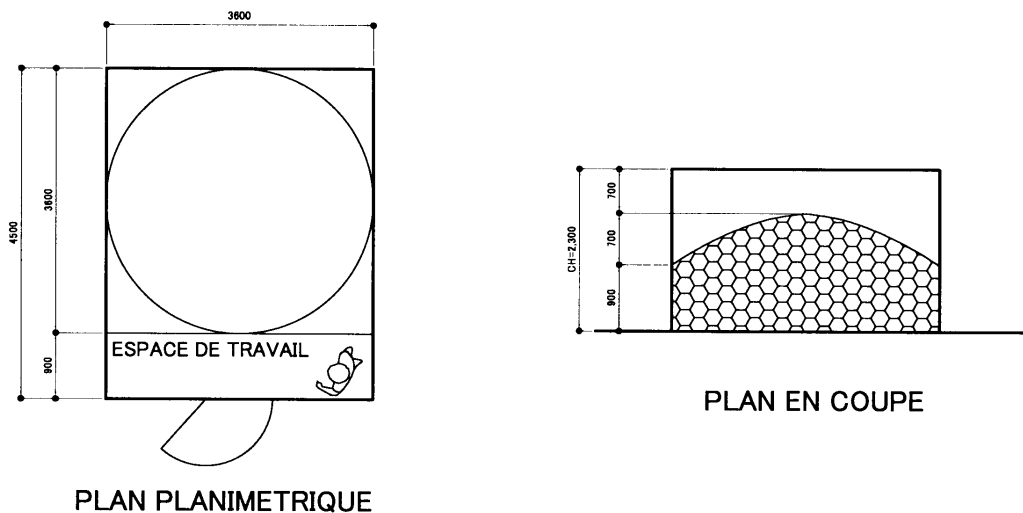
Plan planimétrique et plan en coupe du stockage de glace
